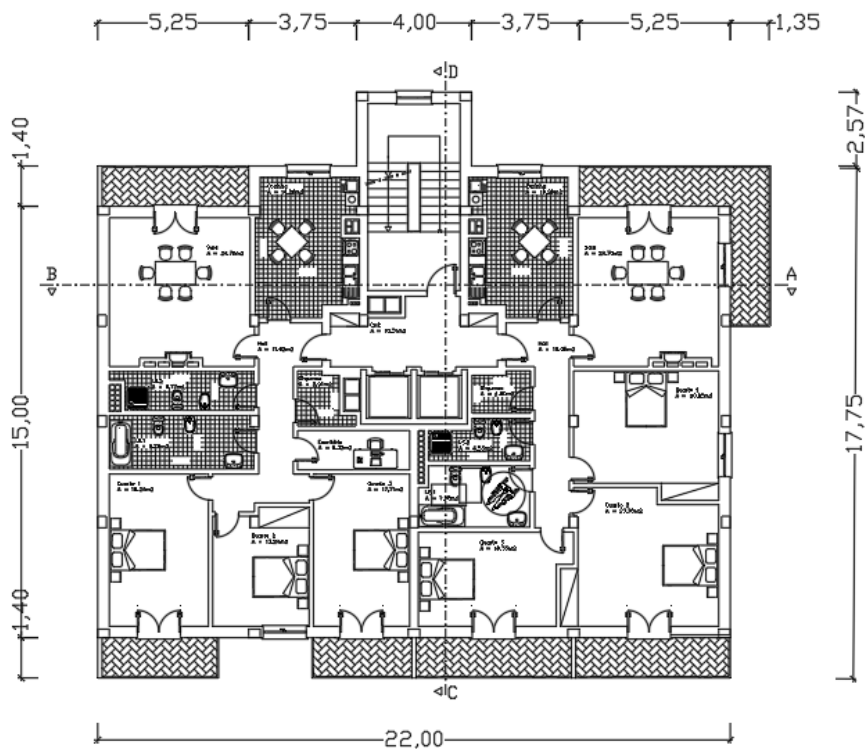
Planta arquitetônica do piso tipo (AutoCad).
